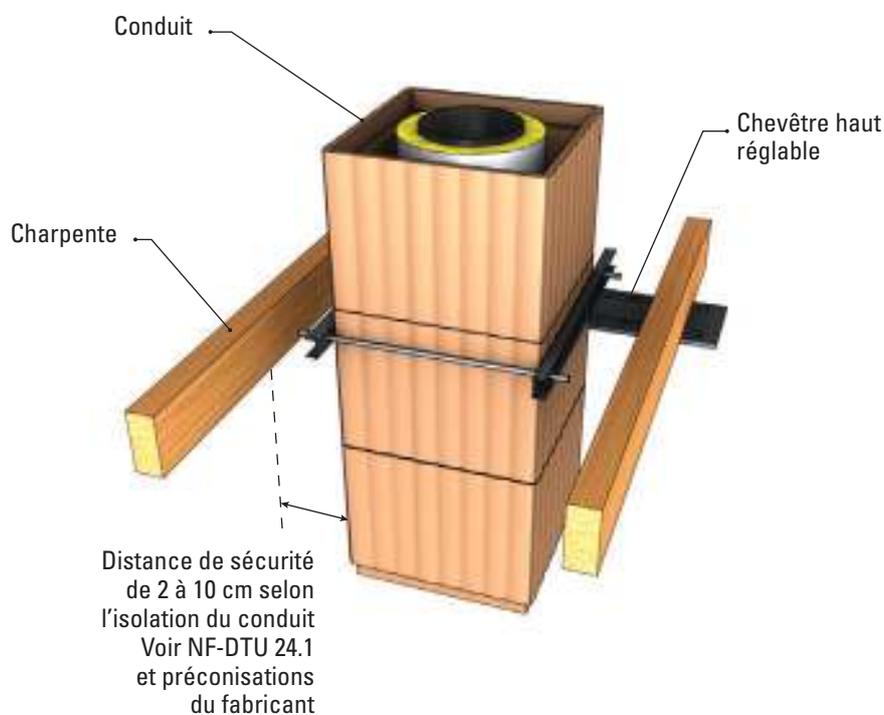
Exemple de traversée des éléments de charpente de la toiture par un conduit maçonné
